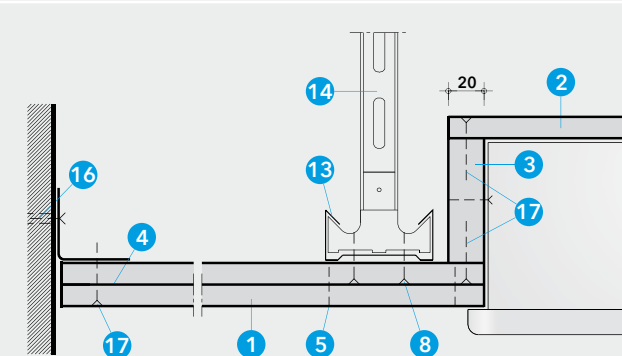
Detail A - Trapezblechdach mit beliebigem Dachaufbau
